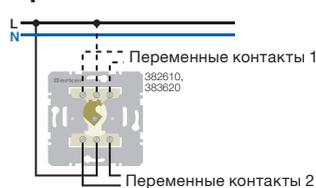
Выключатель/переключатель 1- и 2-полюсный для профильных полуцилиндров [№ для заказа 3826 10, 3836 20]
